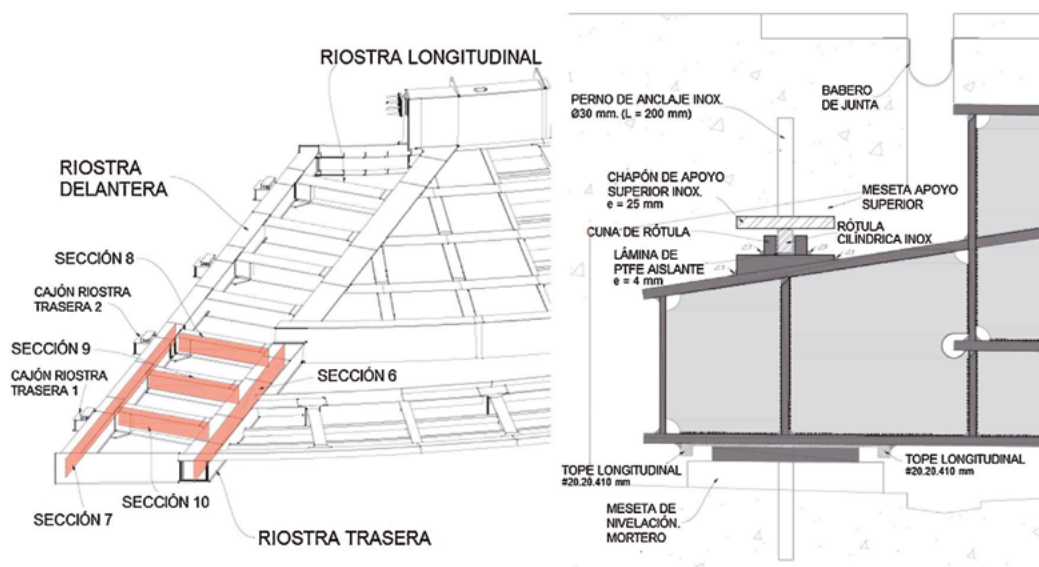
Esquemas del tope deslizante en el empotramiento de los estribos E2 y E3.
